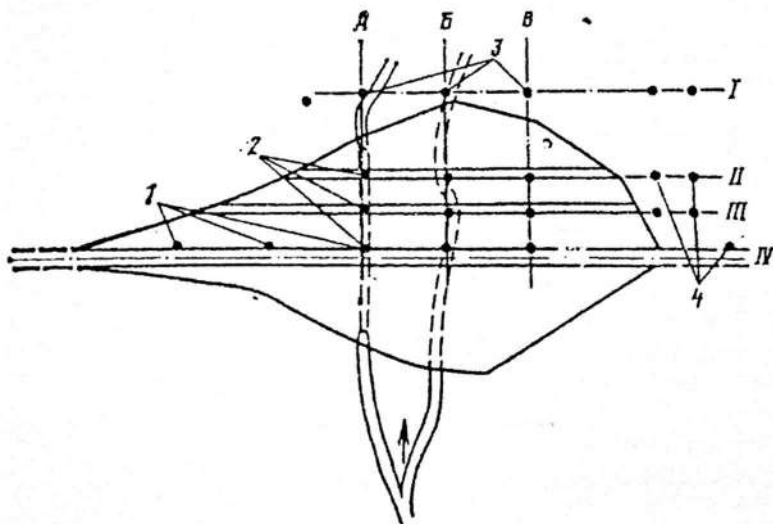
Схемы размещения марок и створных знаков на грунтовой плотине:
